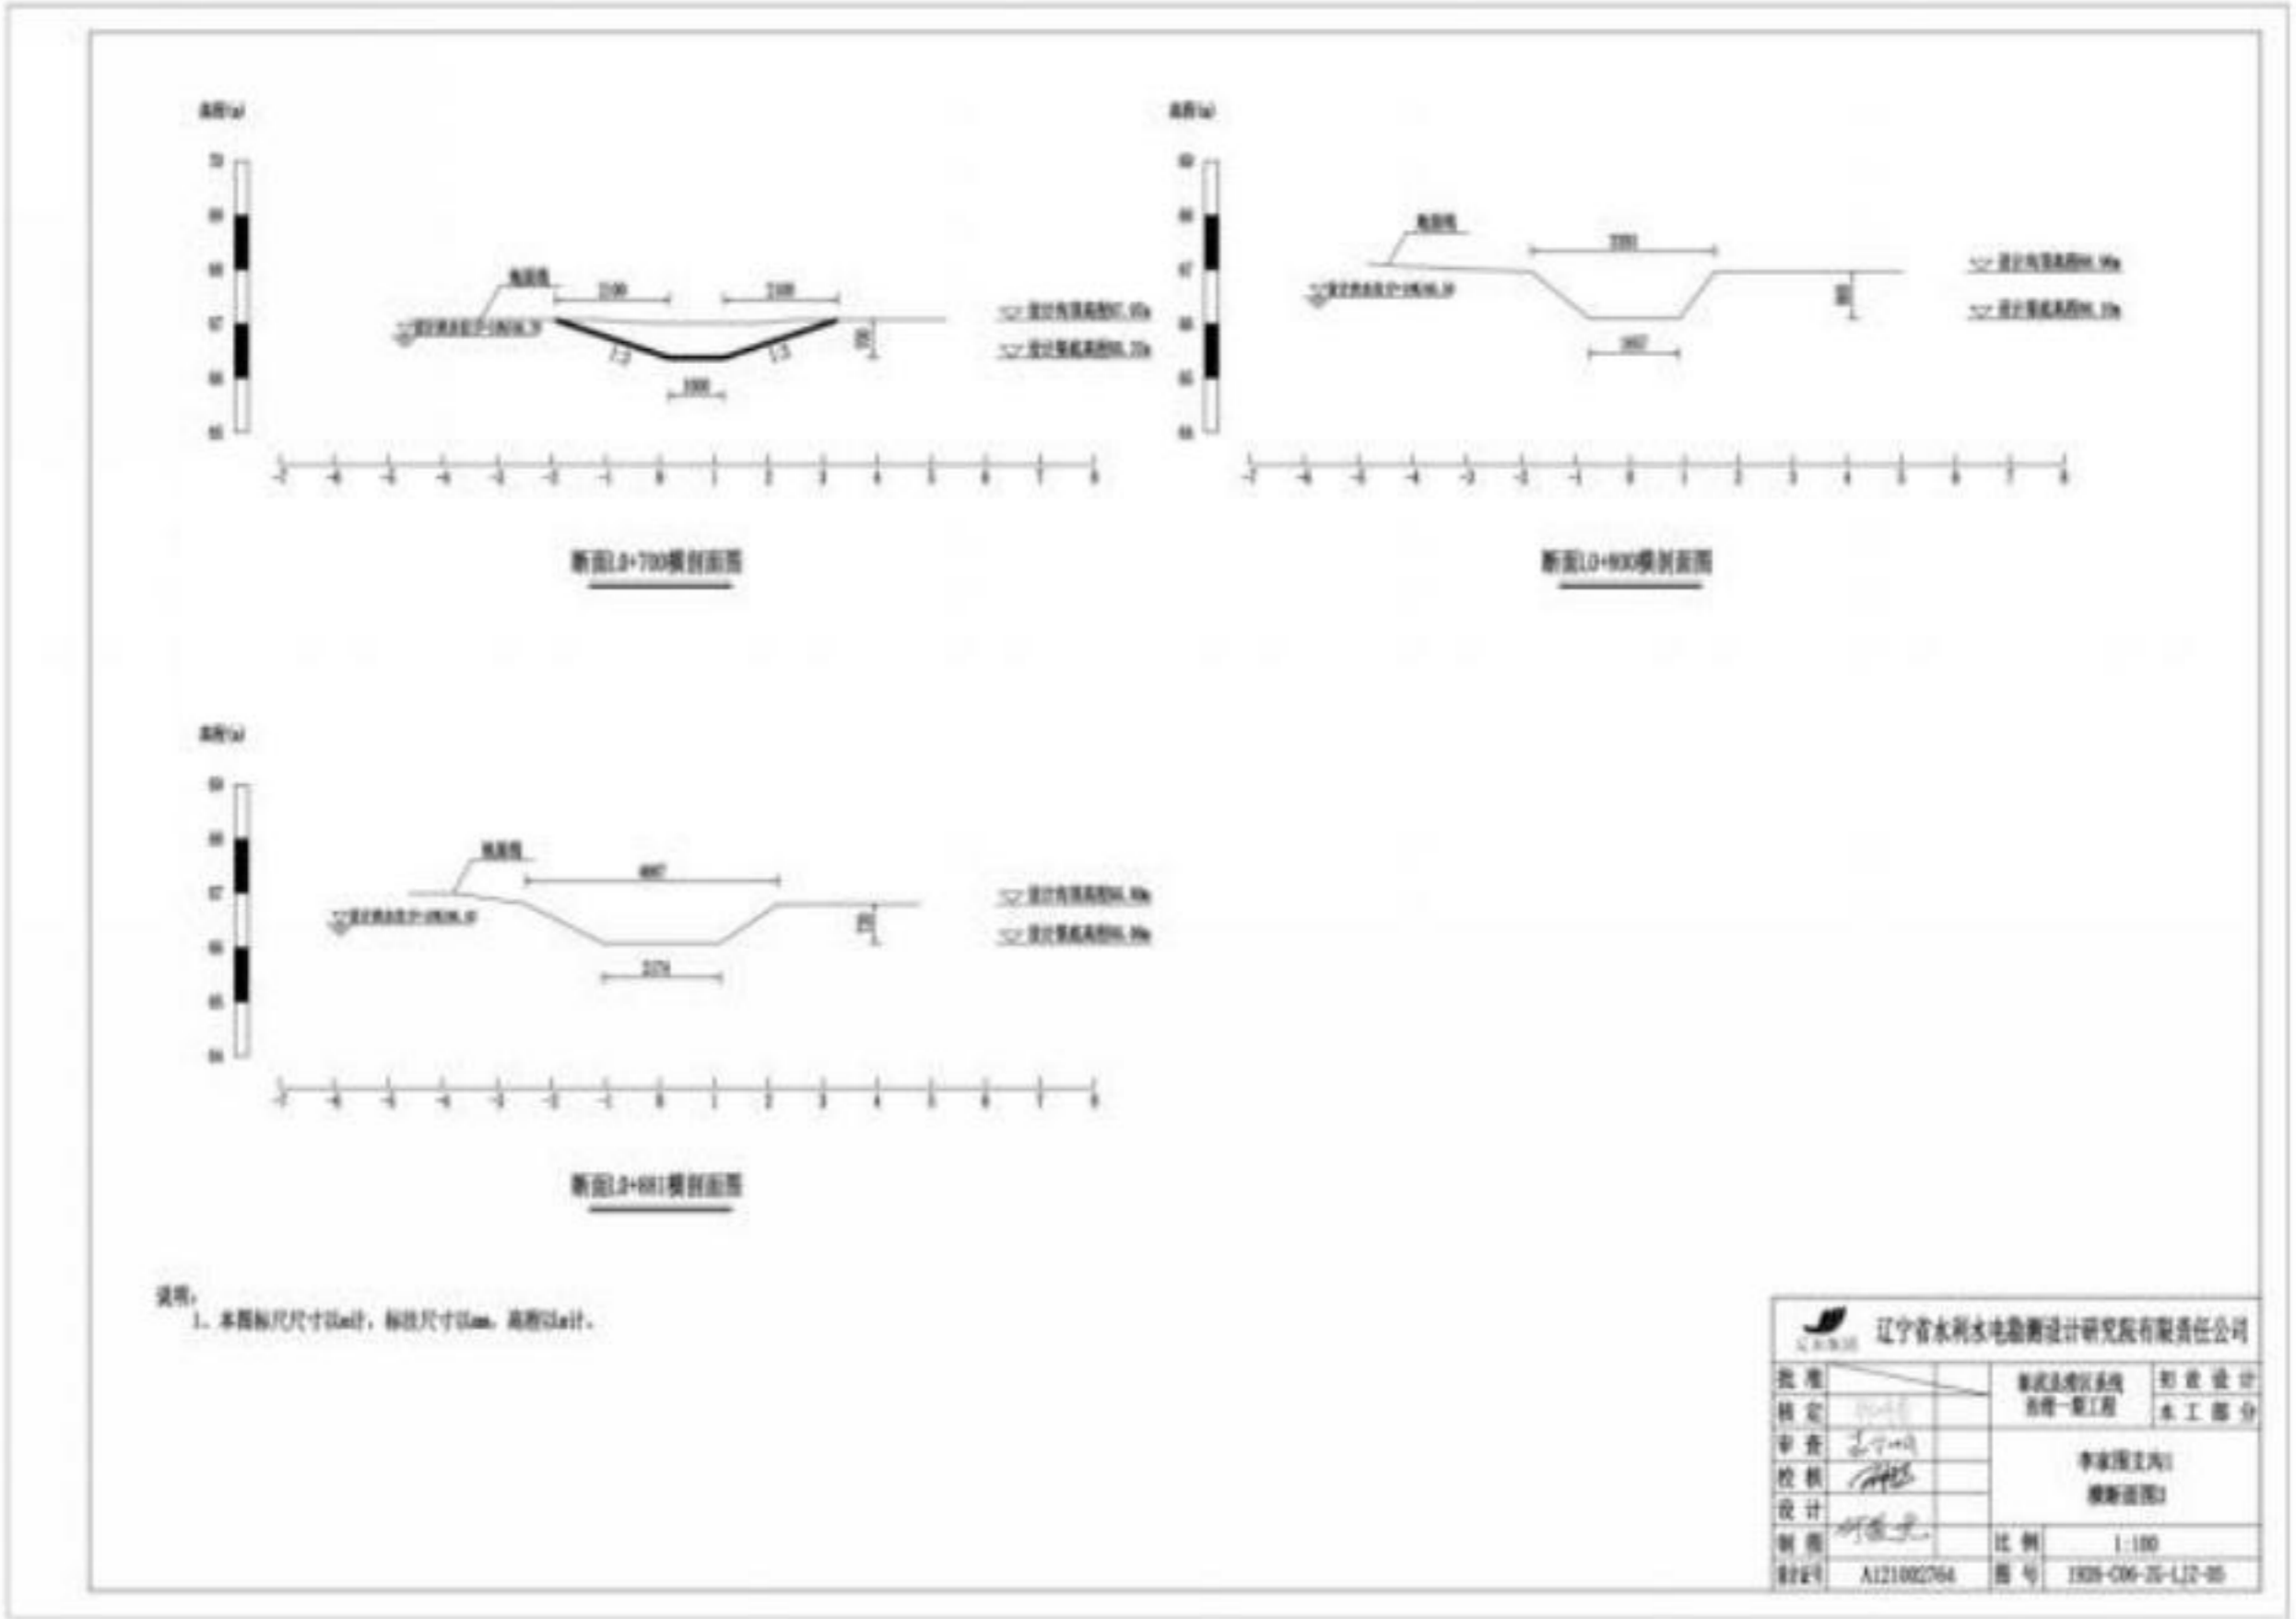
(3) 两家子镇李家围支沟 1 剖面图
